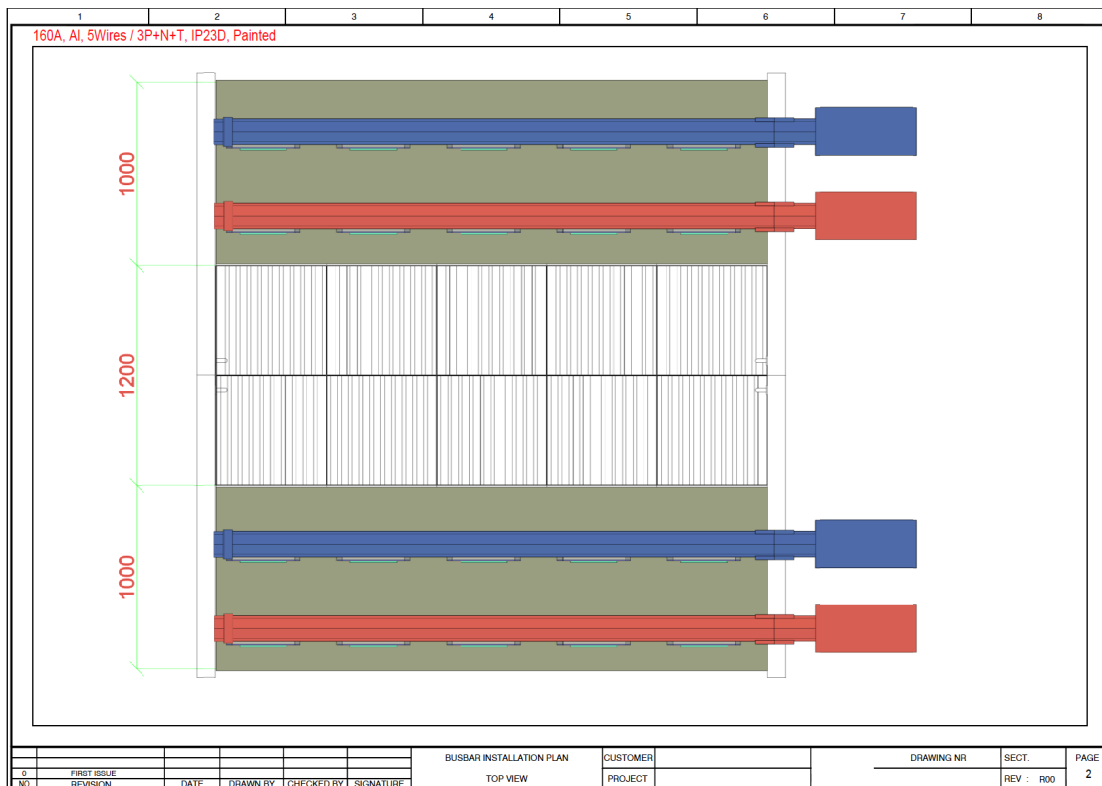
Schema distribuzione in blindosbarre (vista dall'alto)
